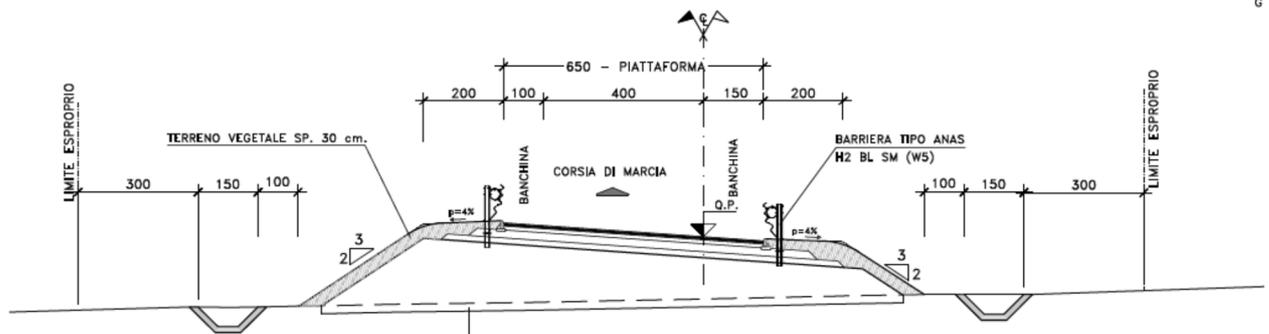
Sezione tipo Rampa di svincolo unidirezionale
